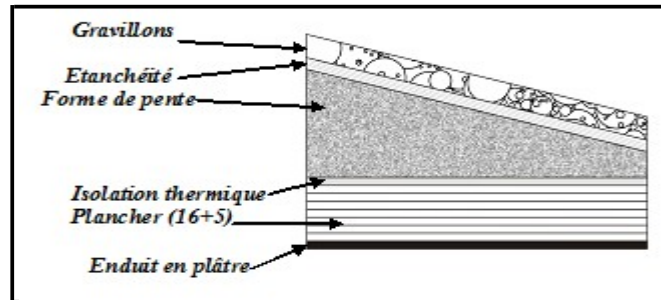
Coupe transversale du plancher de la terrasse inaccessible
